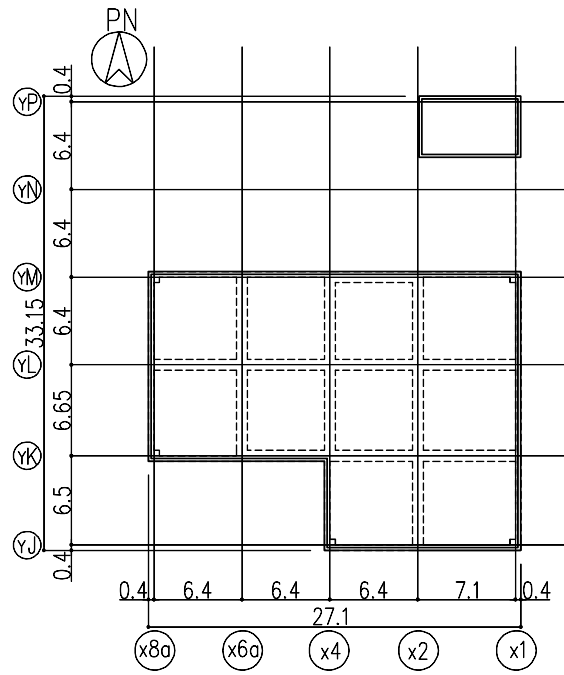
屋上階平面図 (G. L. +15.4) (单位: m)
